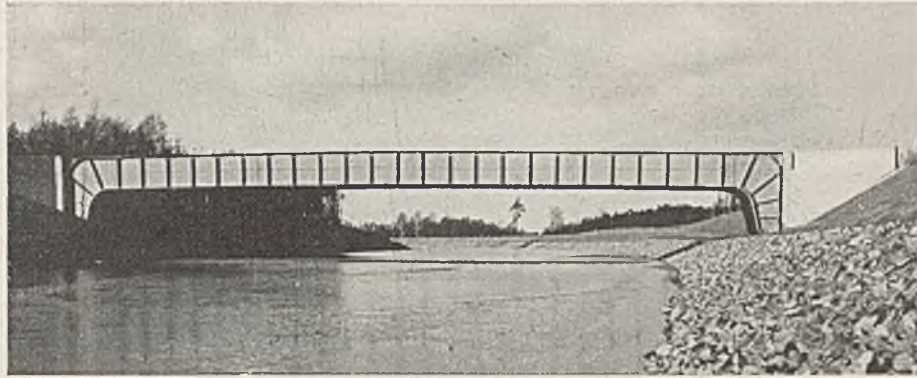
Leisebeinstraßenbrücke (Länge 48 m, Breite 6,20 m).
